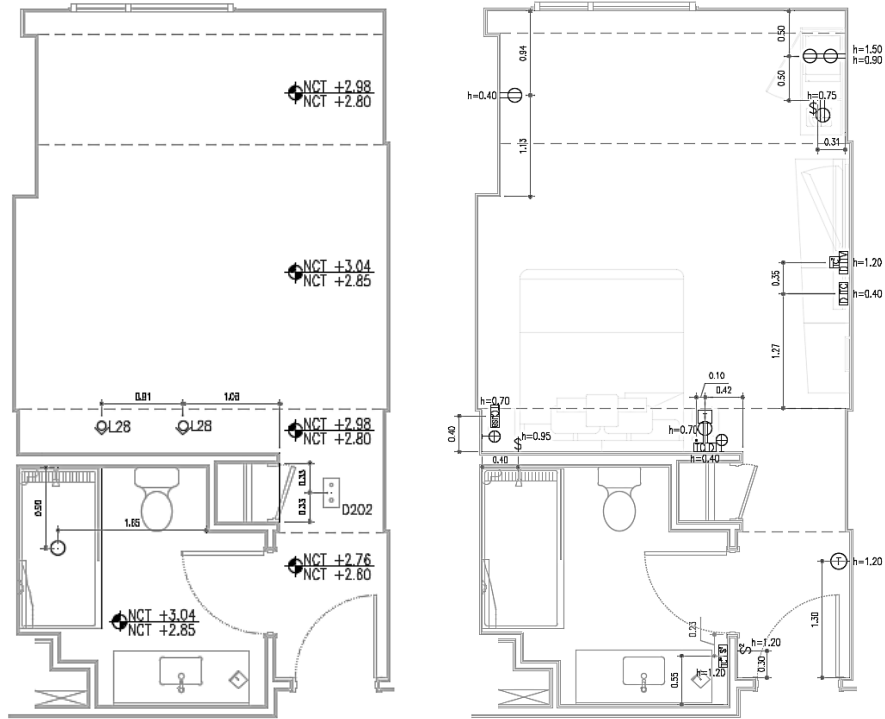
Planta de Cielo y Eléctrica Hab. King Hotel Courtyard
